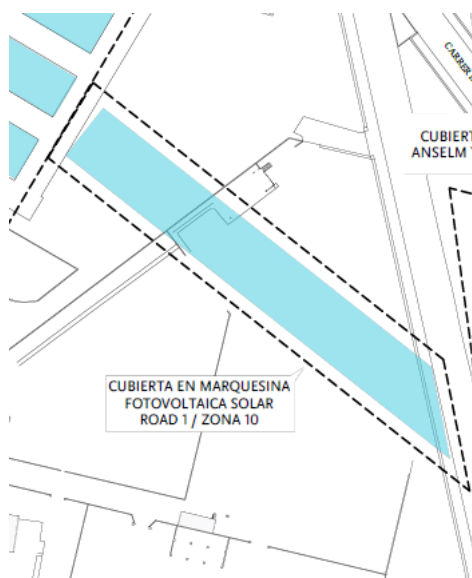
Disposición de las placas fotovoltaicas en Solar Road
